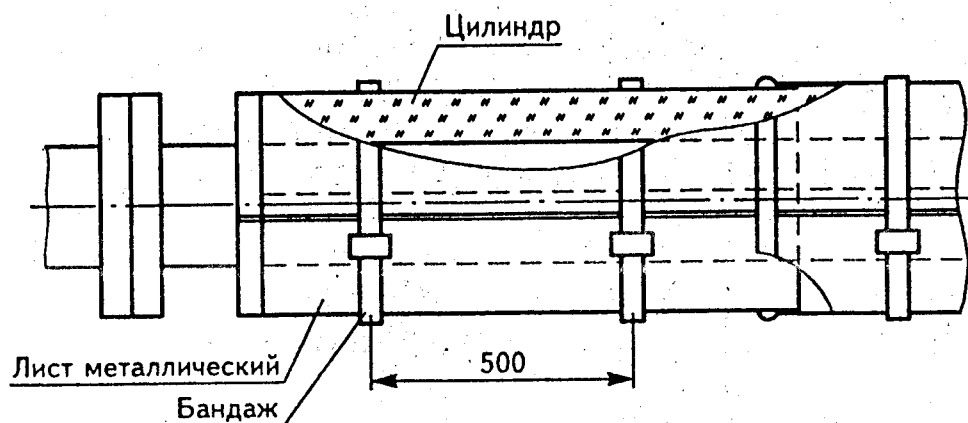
Изоляция цилиндрами. Крепление покрытия бандажами
